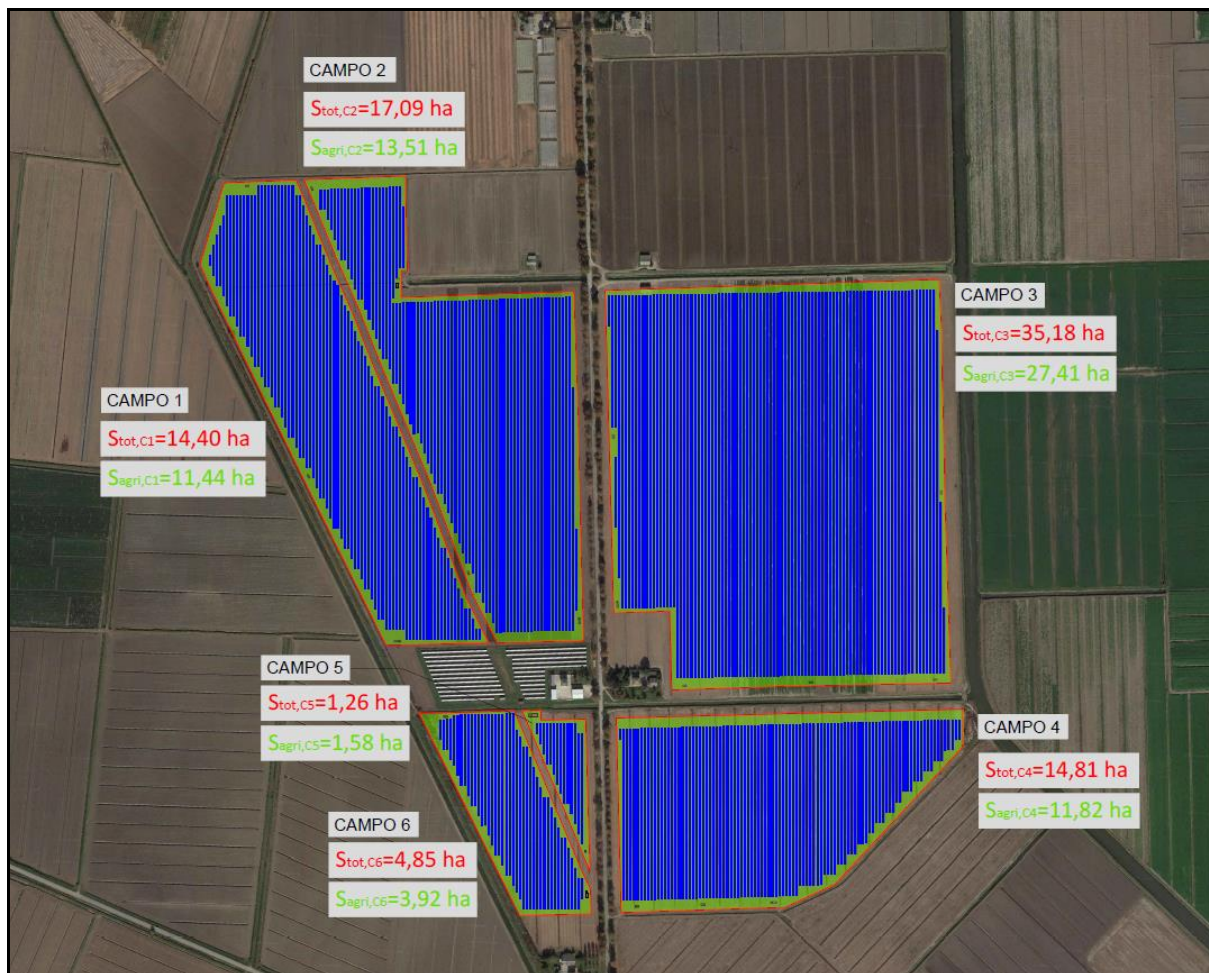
Planimetria delle superfici analizzate per la compatibilità rispetto alle LL.GG.MM.
